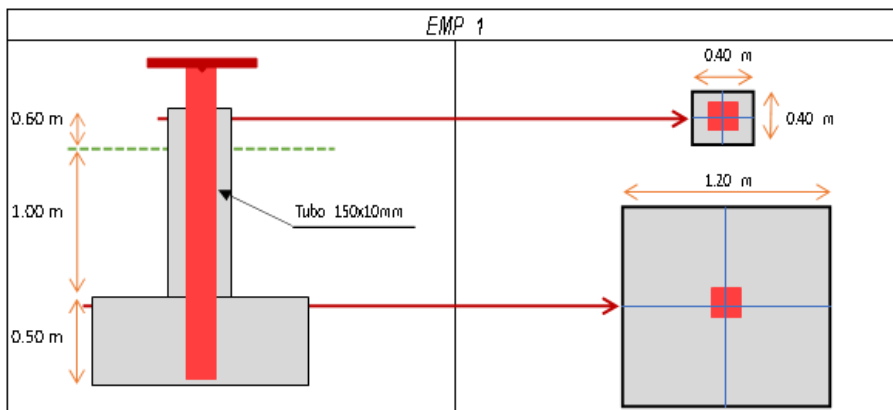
Vista de tubo de acero embebida en concreto. Fuente: Solpesa SAC. (2023).
